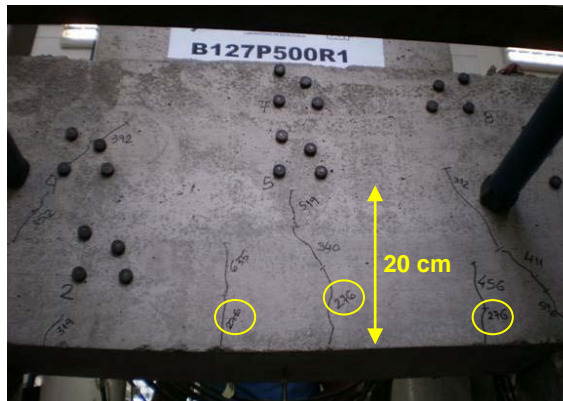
Primeiras fissuras visíveis - B127P500R1
